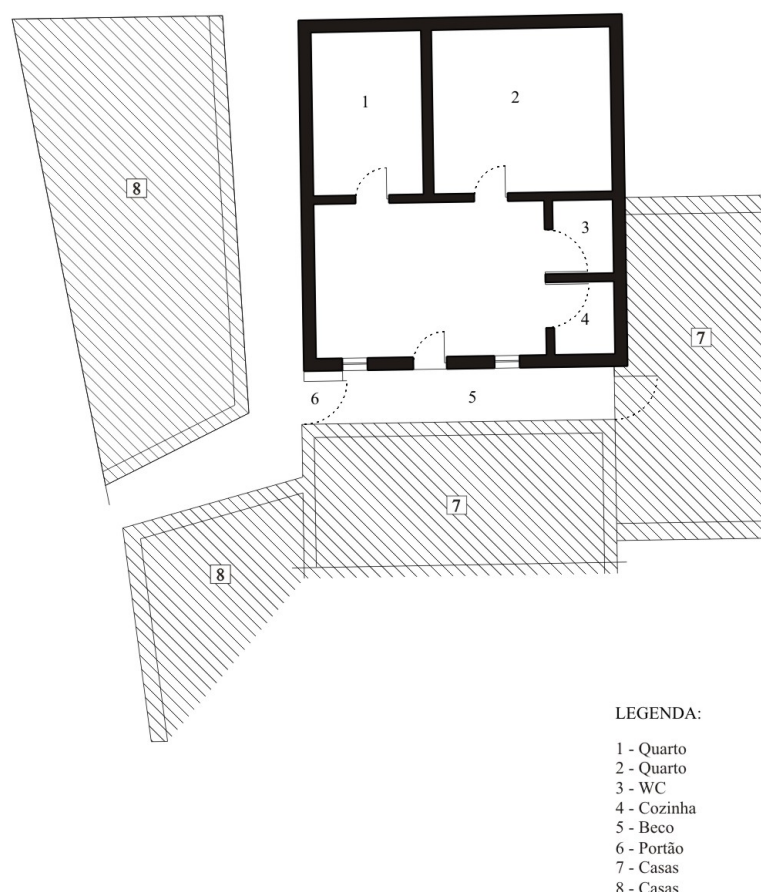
Planta da casa onde Júlio viveu mais recentemente.
